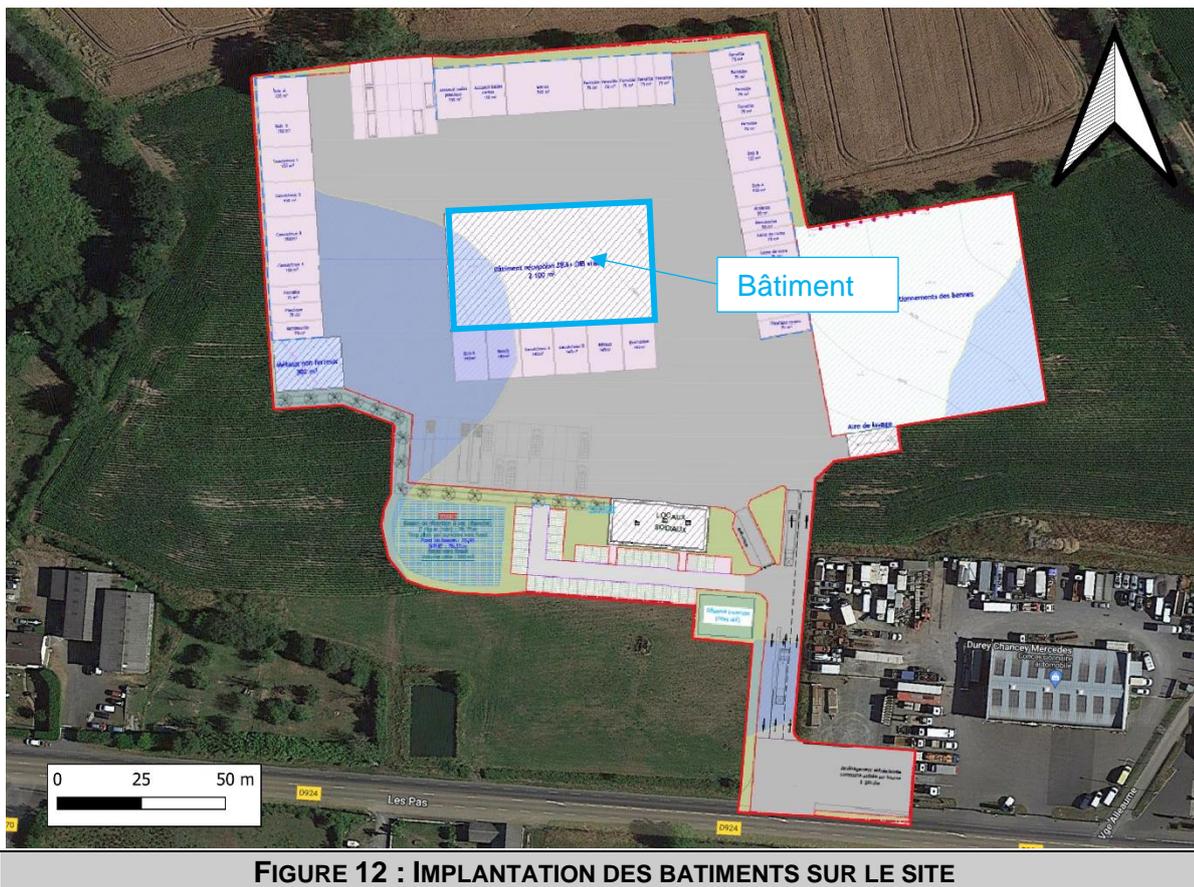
IMPLANTATION DES BATIMENTS SUR LE SITE
